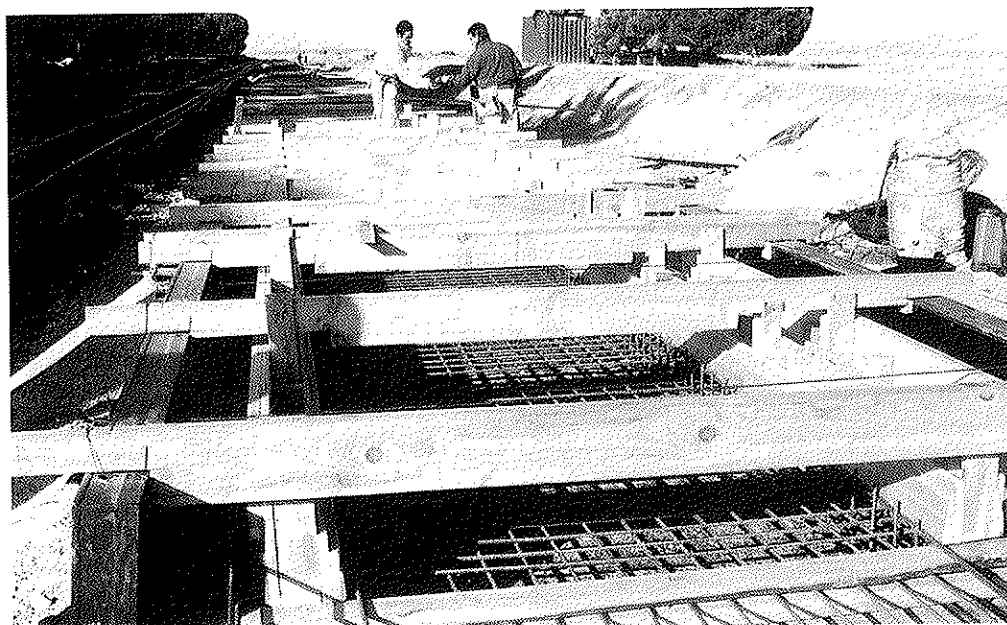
Construcción Viga placa para paso de trenes. Medina del Campo.
